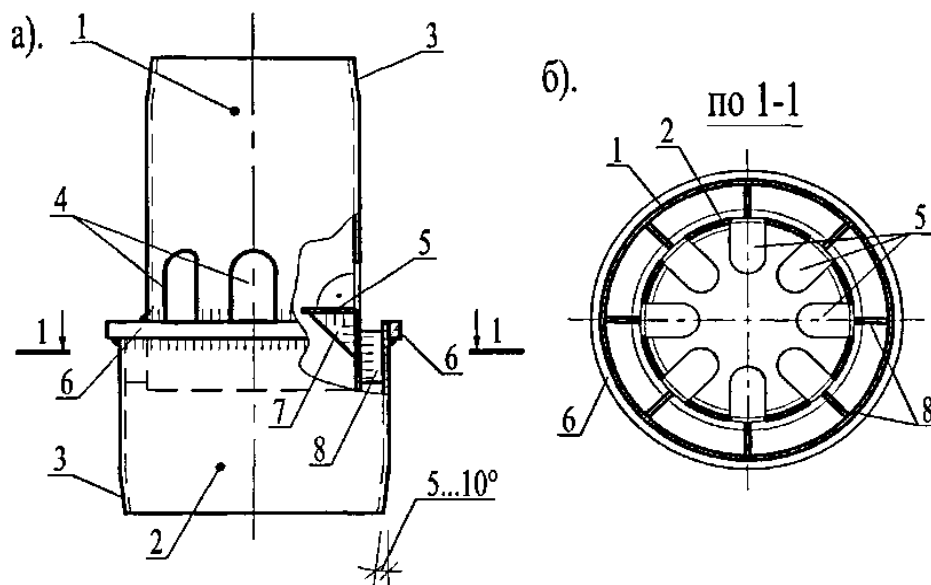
З'єднання трубобетонних колон різного діаметра перехідною гільзою
